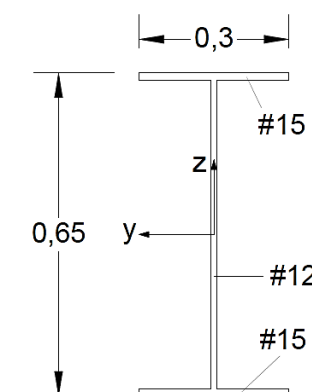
Sección transversal viga de piso en el empotramiento con la viga longitudinal. Elaboración propia con AutoCAD
